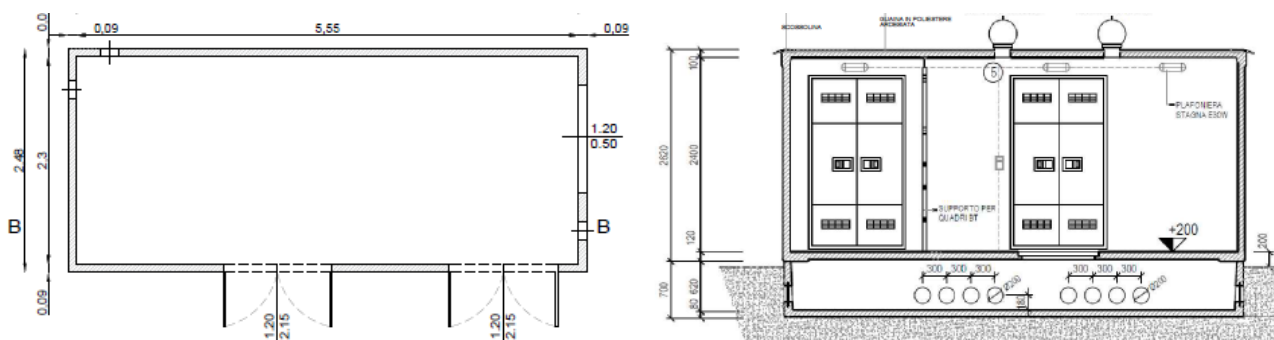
Pianta e prospetto della cabina di sezionamento
